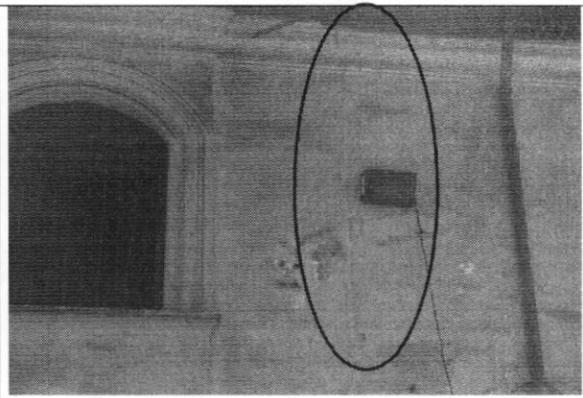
Fisuras muros de segundo piso, costado occidental
